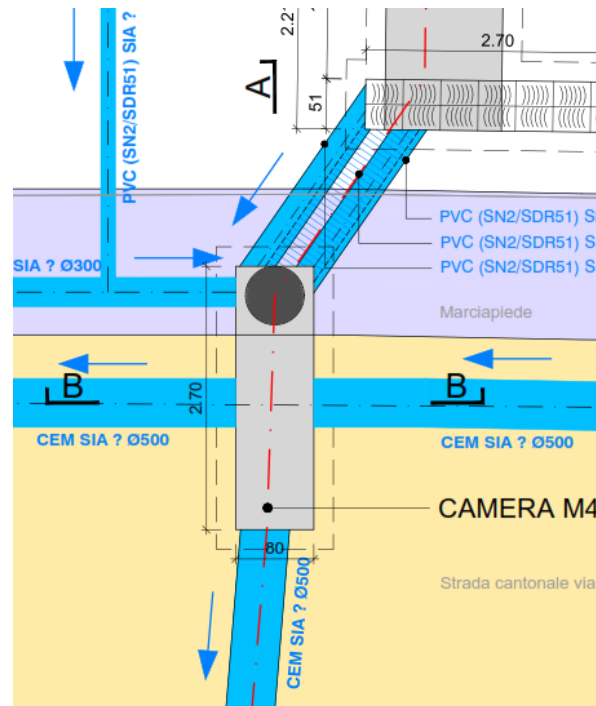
Situazione in planimetria dell'incrocio delle condotte nel pozzetto M4
